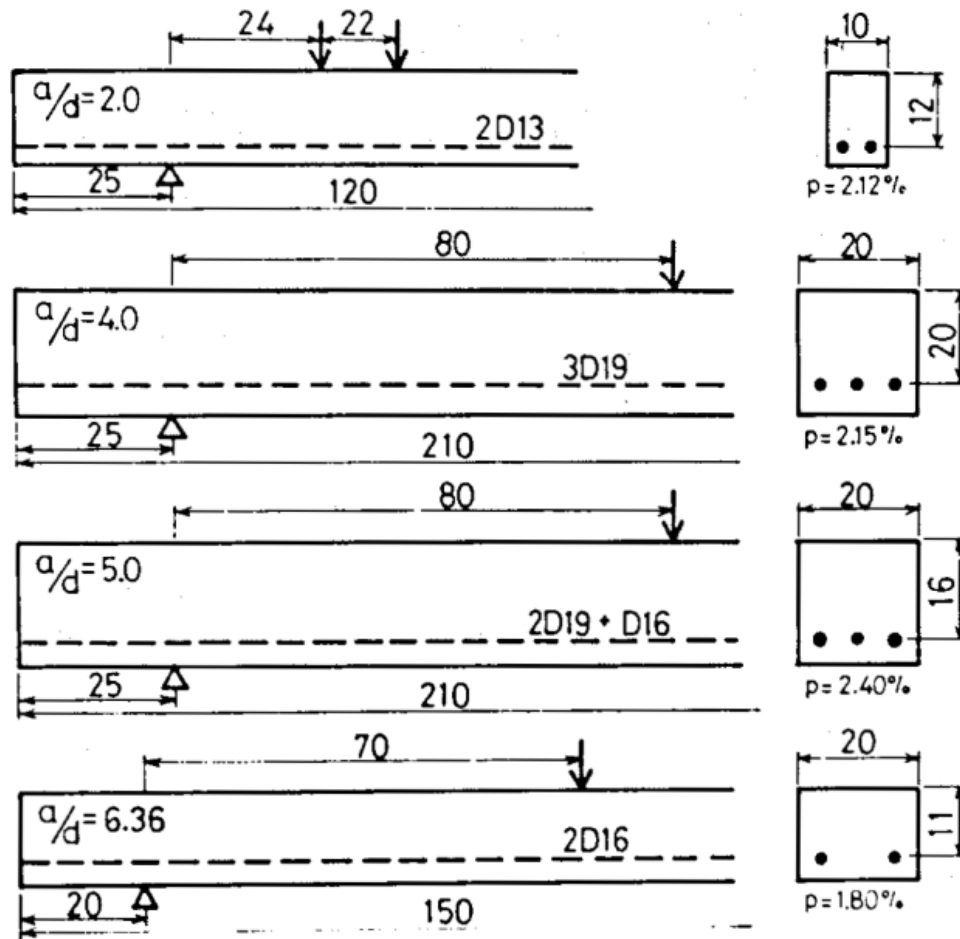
Posições das cargas nas vigas e seções transversais, dimensões em cm (HIGAI, 1978).
